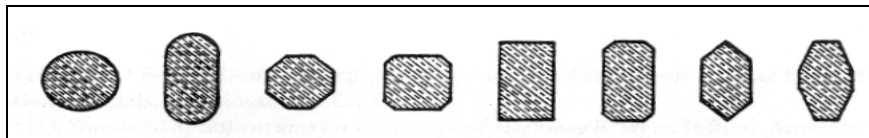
Secciones transversales típicas de pilas para puentes o viaductos en tierra.
